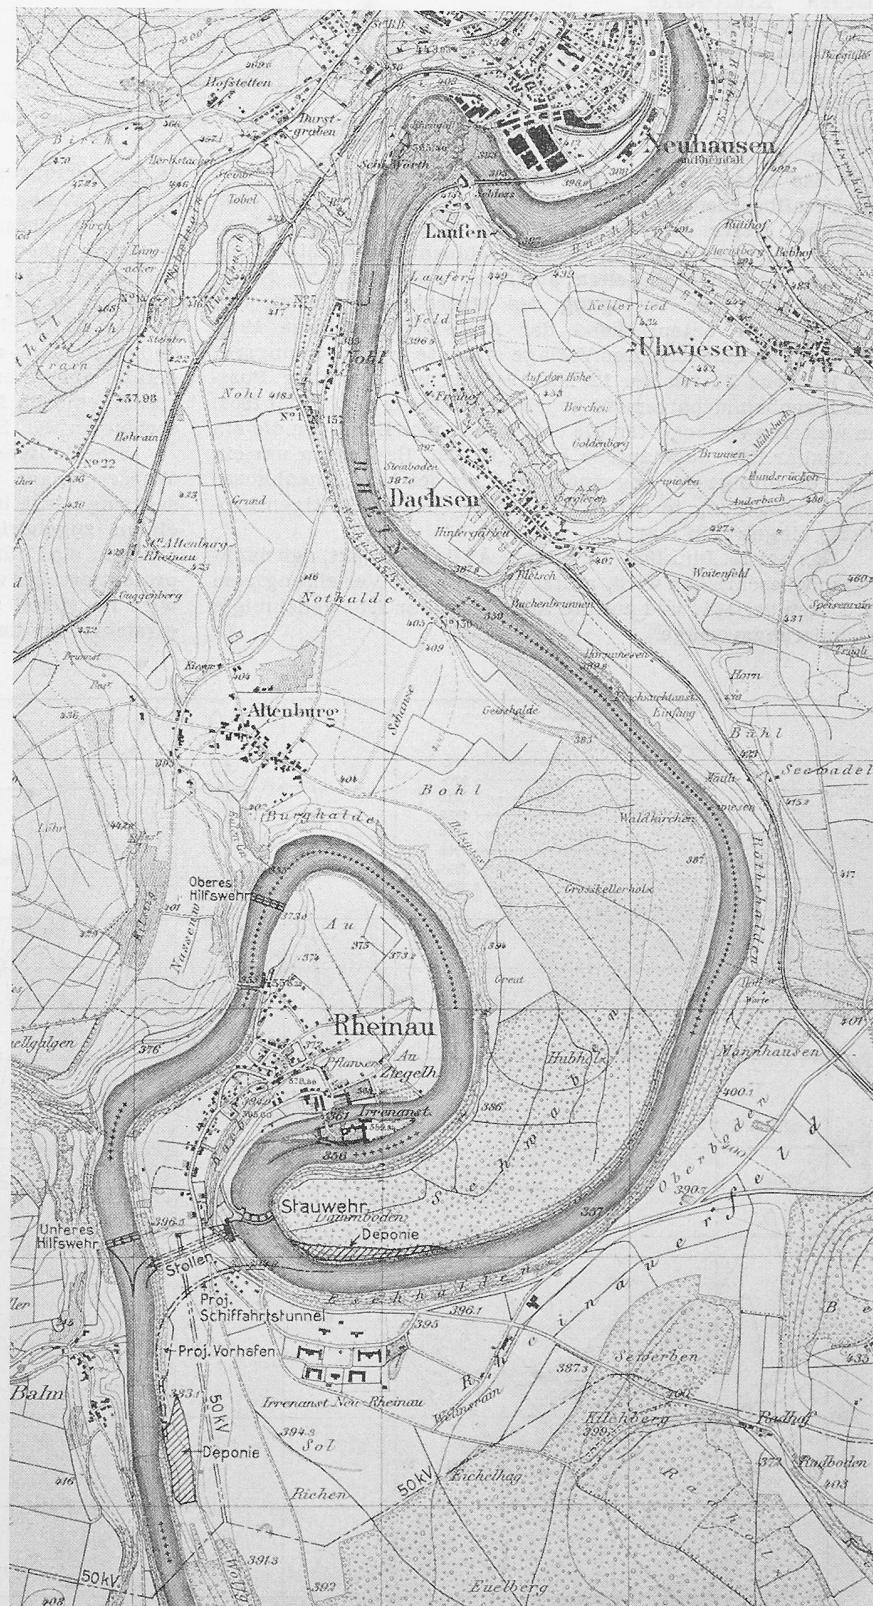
Lageplan des Kraftwerkes Rheinau, Maßstab 1:30 000.
